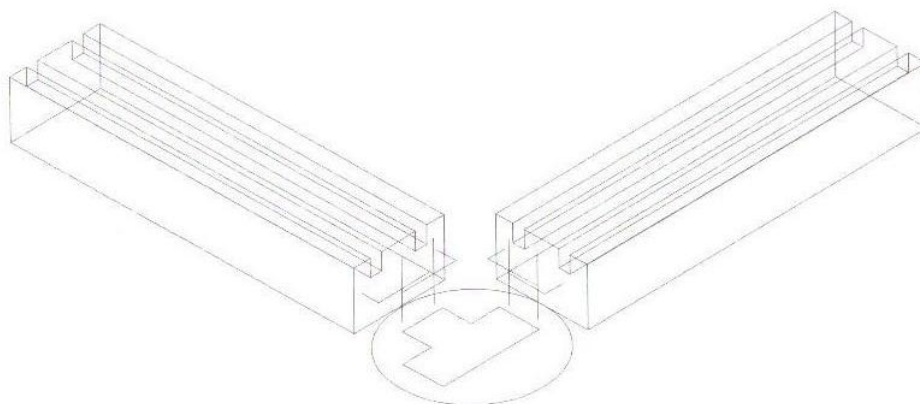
Detalhes da fixação das vigas baldrames nas esperas
